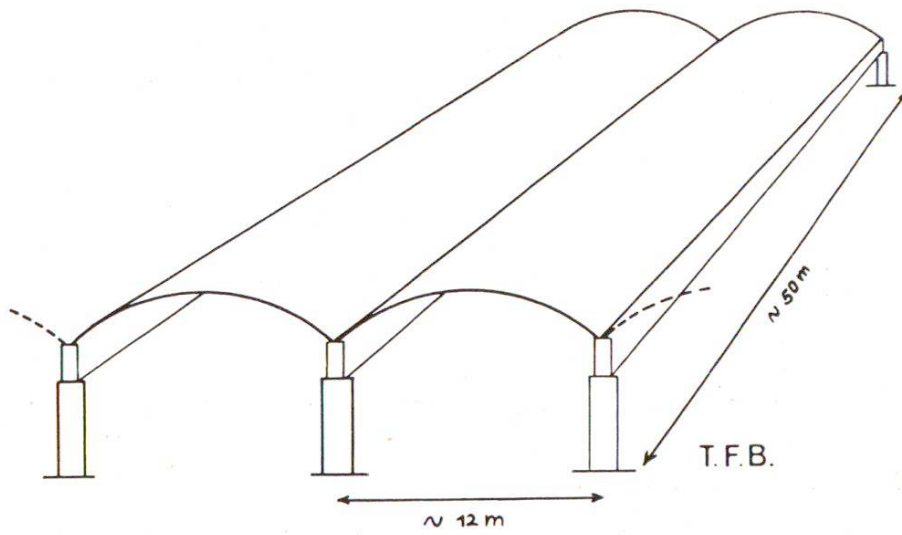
Voûtes cylindriques portées par des sommiers précontraints. (Concrete and Constructional Engineering, 47, 8, (1952)
